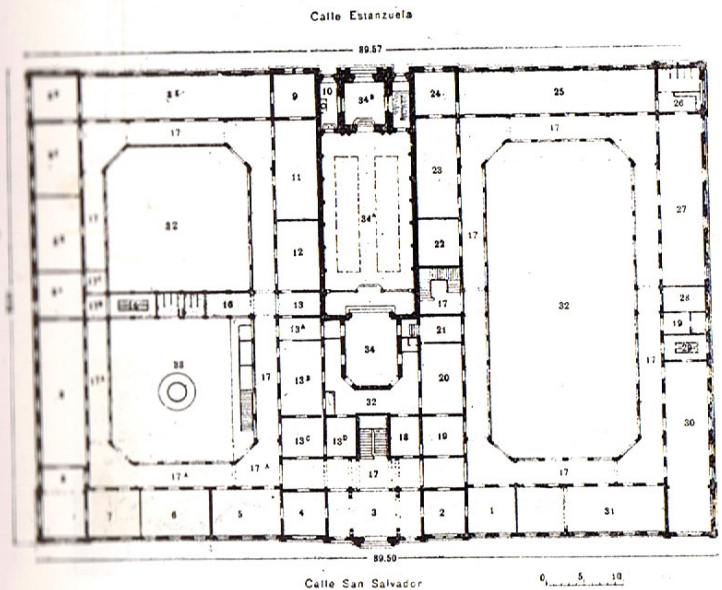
Asilo Dámaso Larrañaga — Planta.
